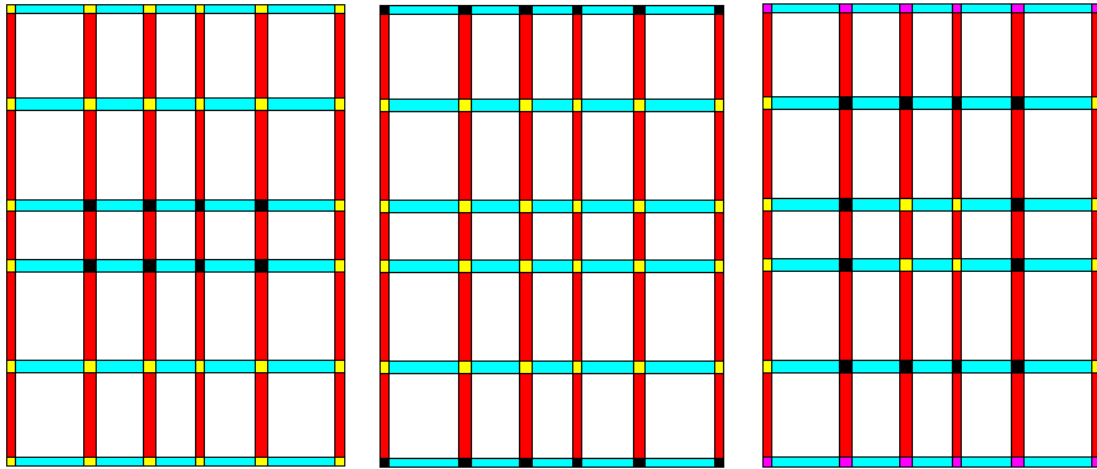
Disposición de las columnas y vigas en el sistema estructural de los edificios aislados de deriva 0,4%. Suelo firme (a), suelo intermedio (b) y suelo blando (c).
